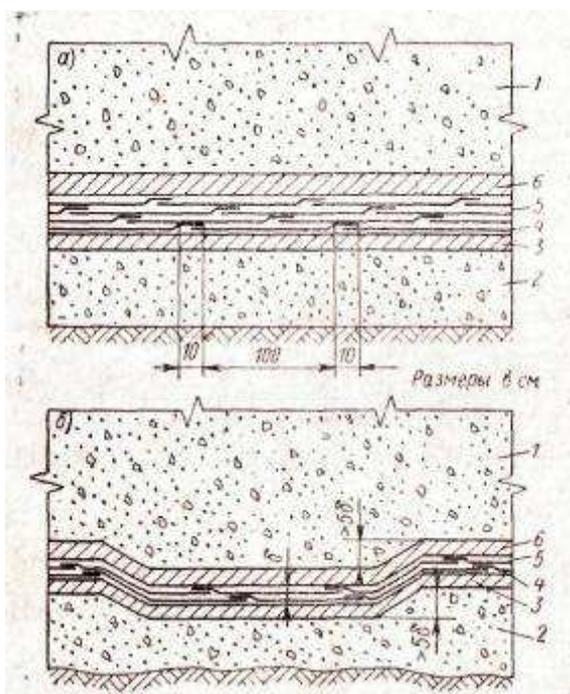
Конструкция оклеечной гидроизоляции на горизонтальной плоскости (к п. 3.48)
